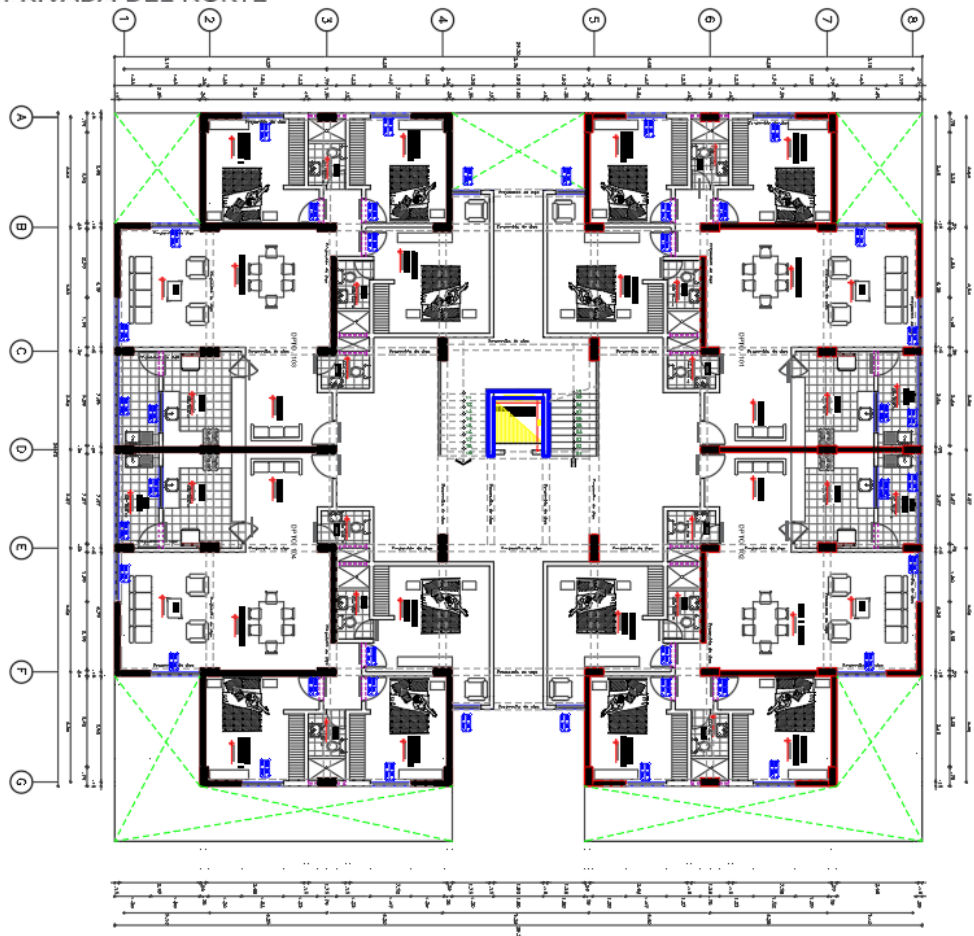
Vista en planta de la arquitectura del edificio – piso de 2 al 11
